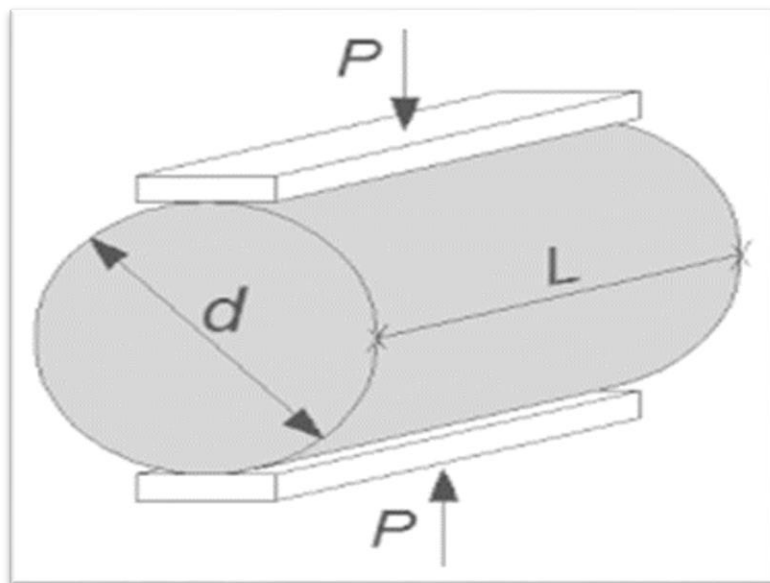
Fuerzas sometidas al concreto cilíndrico en el ensayo a tracción.
